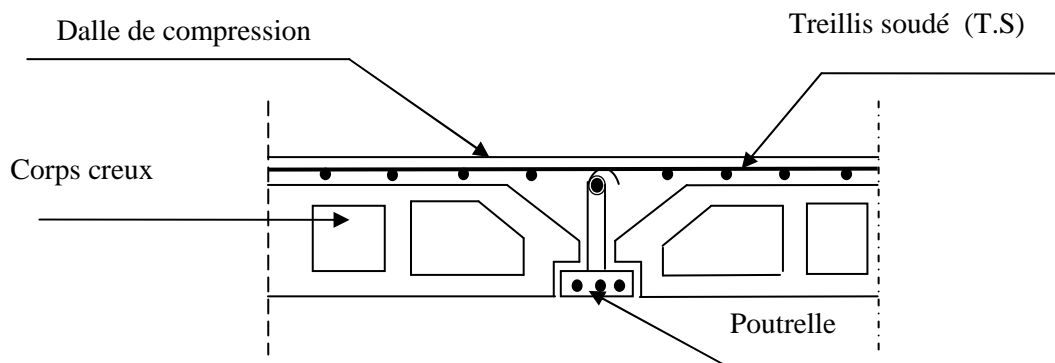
Coupe transversale dans un plancher en corps creux
